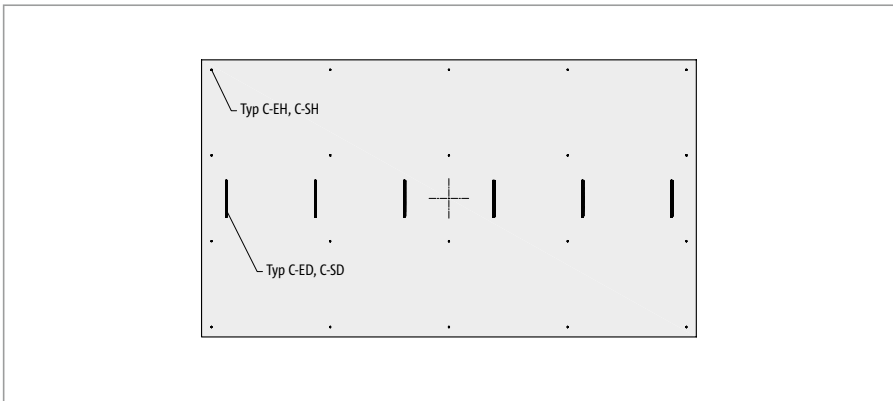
Schöck Isolink®: Fragment van de buitenschil; type C-EH, C-SH wordt in een kwadratisch rooster geplaatst
